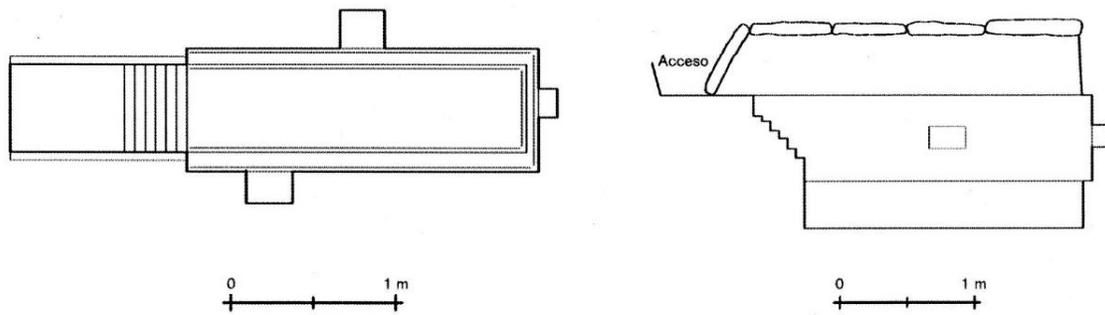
Croquis de la tumba 8 del sitio Cerro Guacamaya. Planta y Alzado del muro sur.
